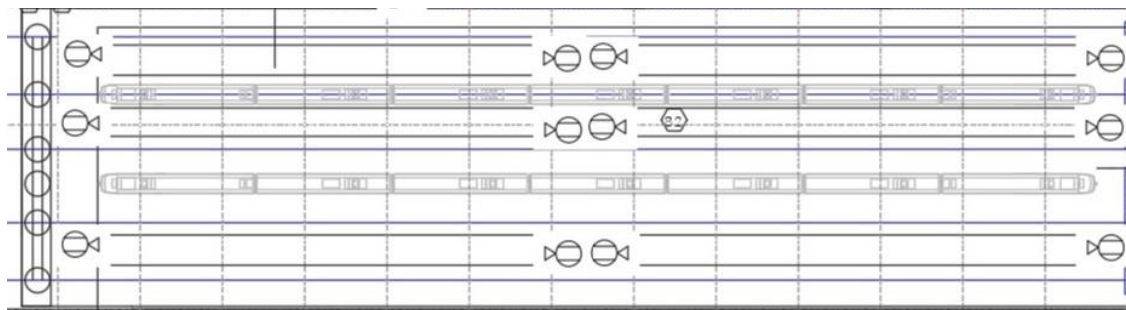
Sistema CCTV Planta Mantenimiento Mayor
